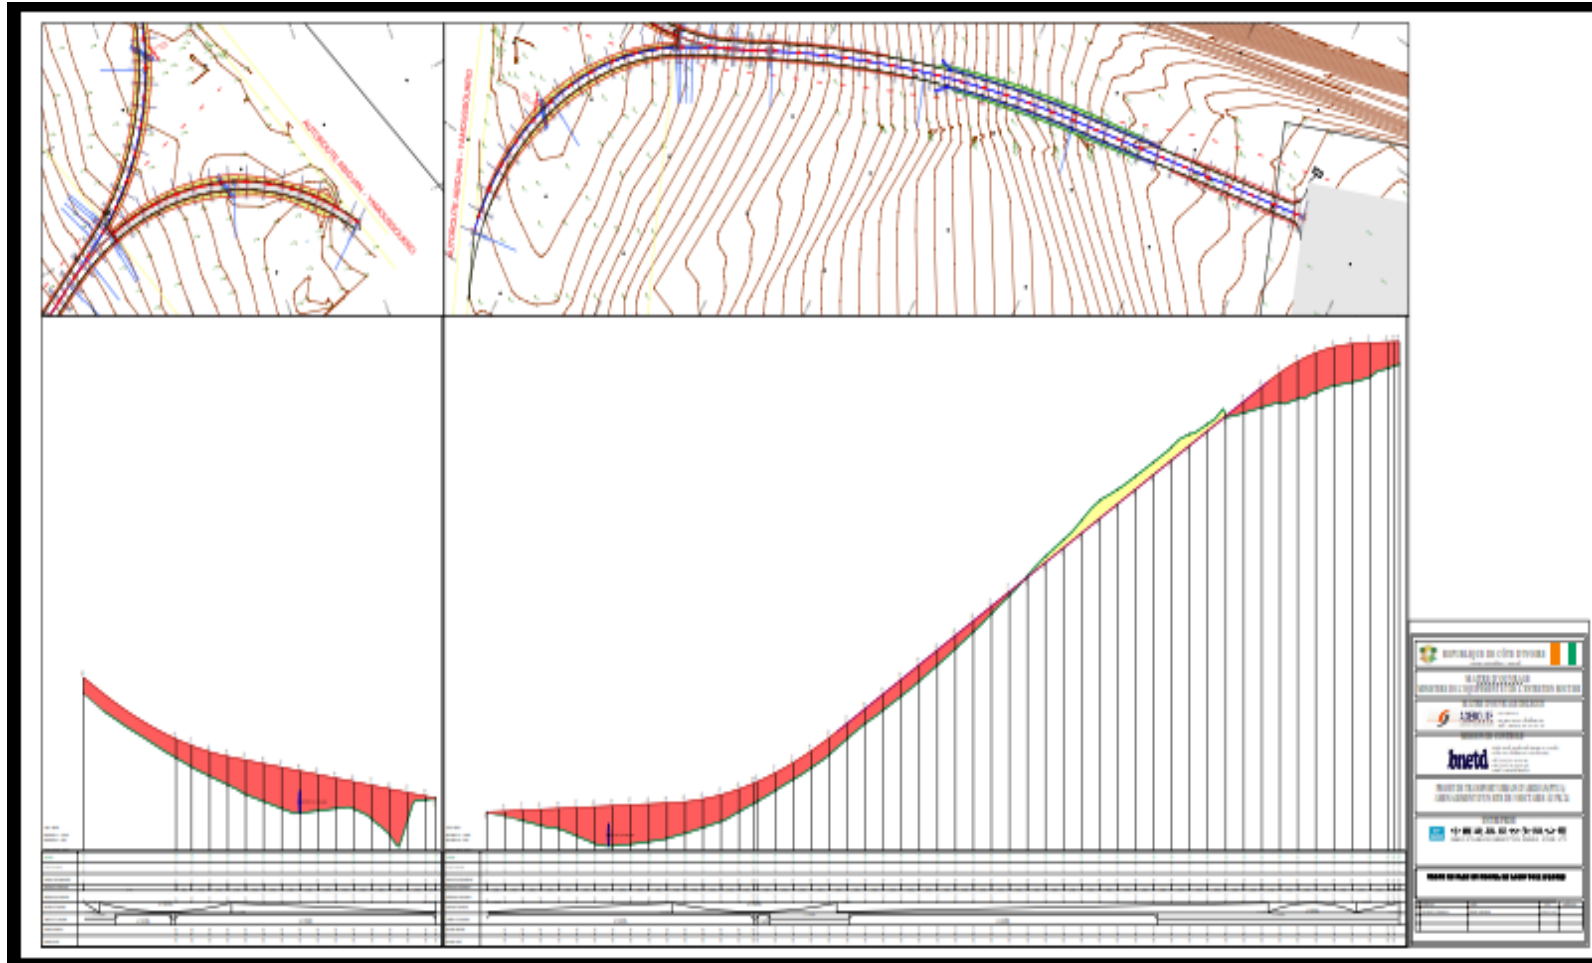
Plan d'aménagement des voies d'accès et sortie au site
